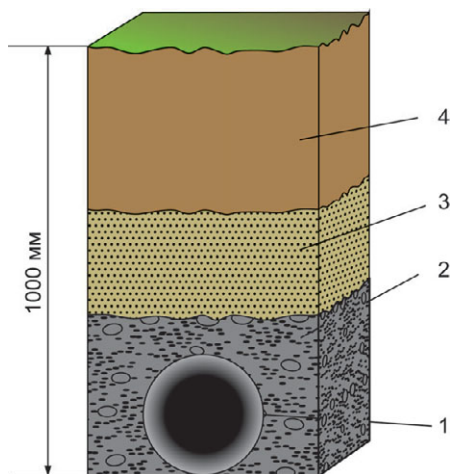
Укладка канализационного трубопровода в траншею: 1 — полипропиленовая канализационная труба диаметром 110 мм; 2 — теплоизоляционный слой; 3 — щебень; 4 — утеплитель (пенопропилен); 5 — грунт
